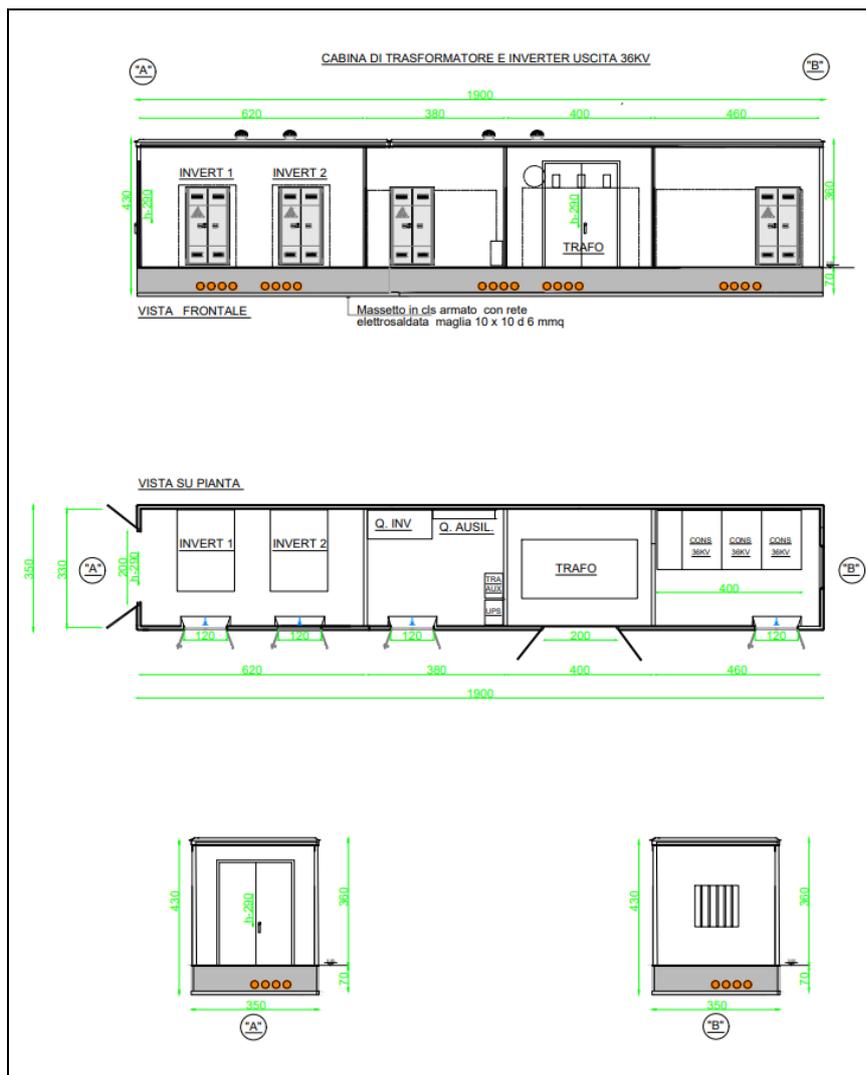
Planimetria e prospetti dell'unità di trasformazione
